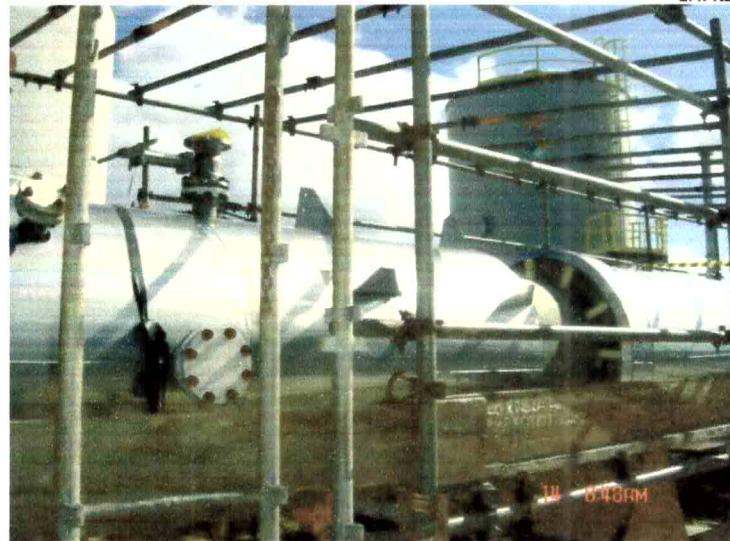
Detalhe da montagem do revestimento sobre os espaçadores e fixação com borrachas
